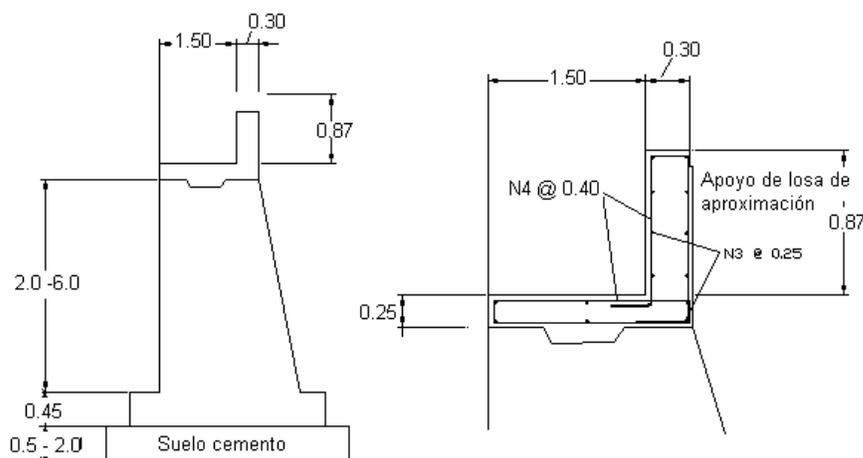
Cabezal de estribo para puentes metálicos modulares.
